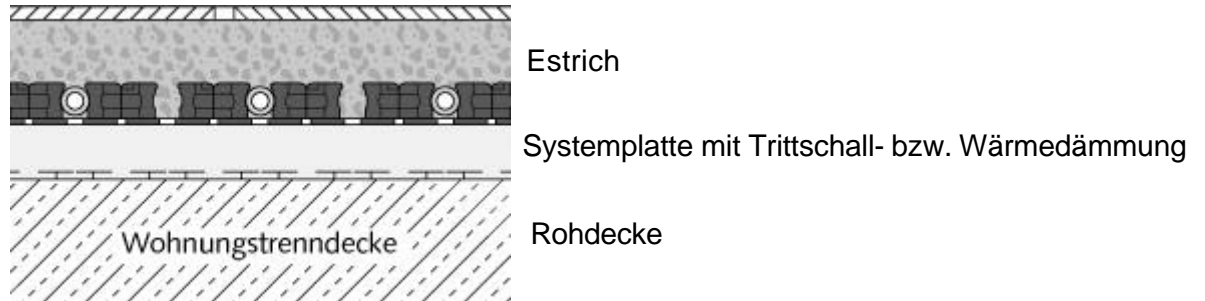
Schematischer Deckenaufbau der Geschossdecke mit Fußbodenheizung. Im Leistungsverzeichnis nicht enthalten: Estrich.
